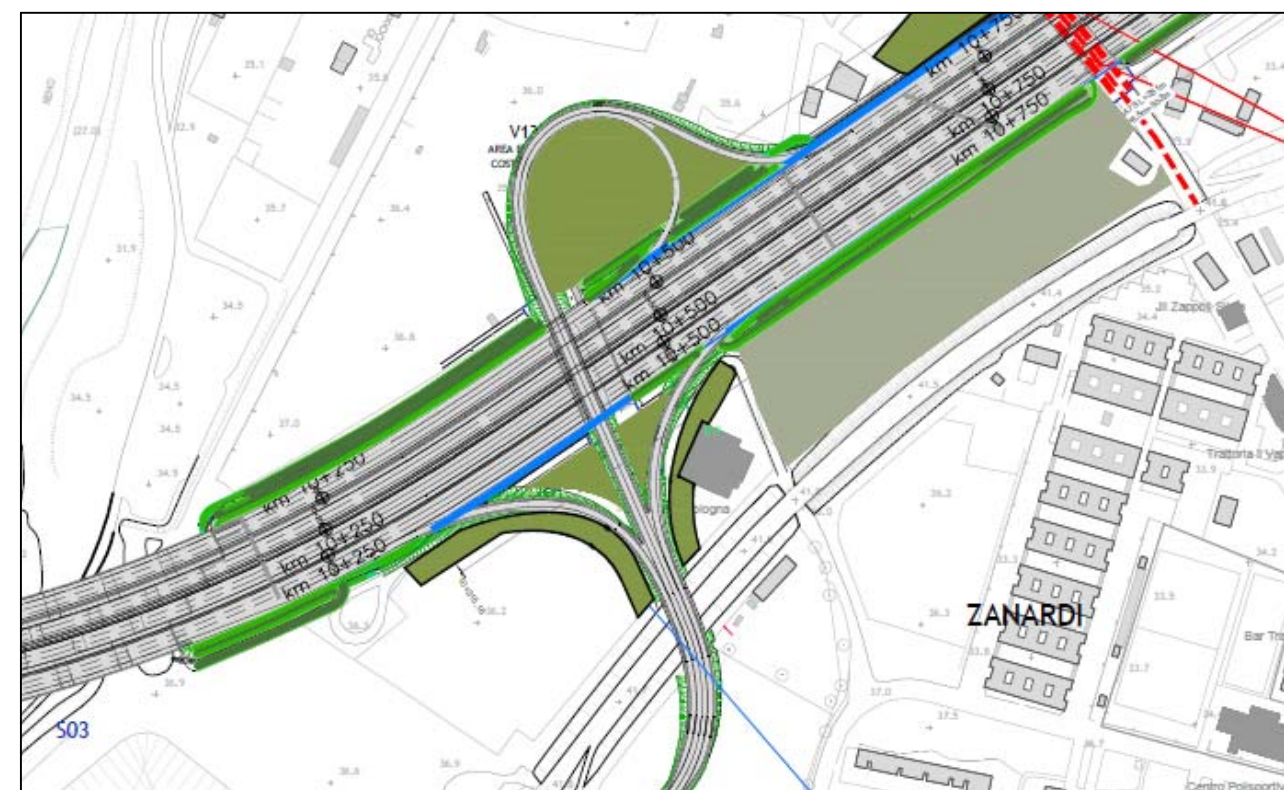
Dettaglio planimetrico dello Nuovo svincolo Lazzaretto
